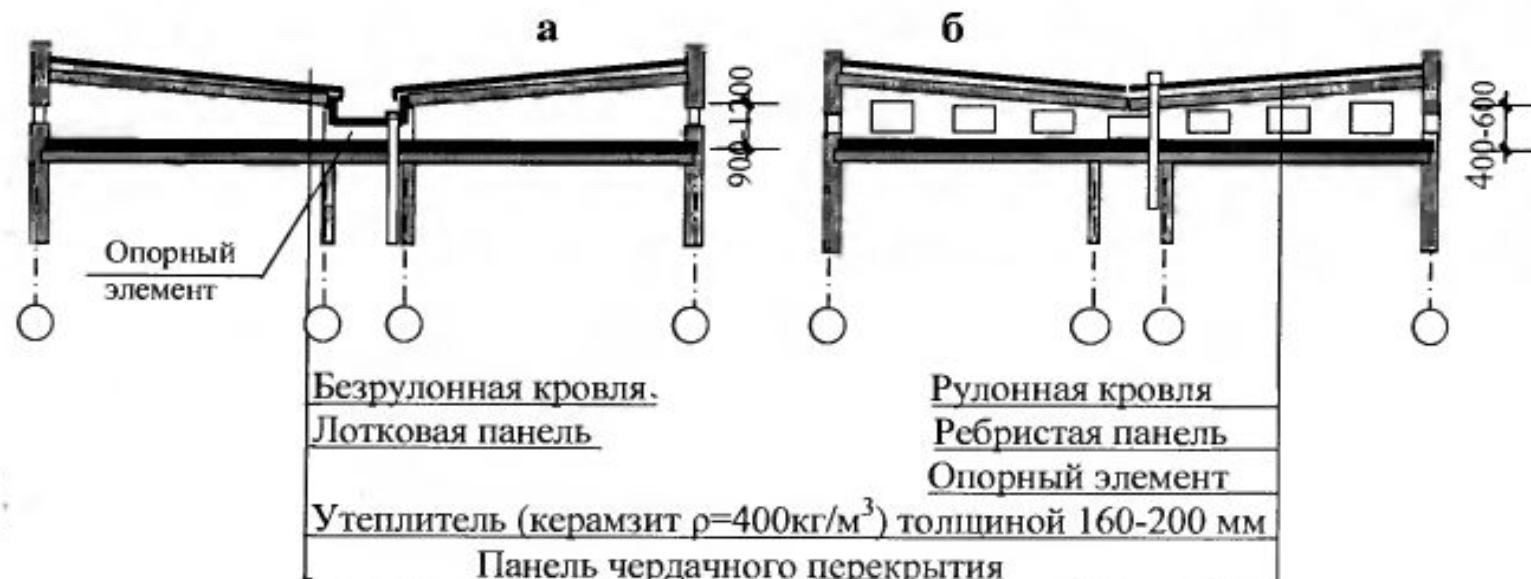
Виды чердачных вентилируемых покрытий панельных зданий; а – с лотковыми панелями крыши; б – с ребристыми плитами крыши и поперечными опорными элементами.
